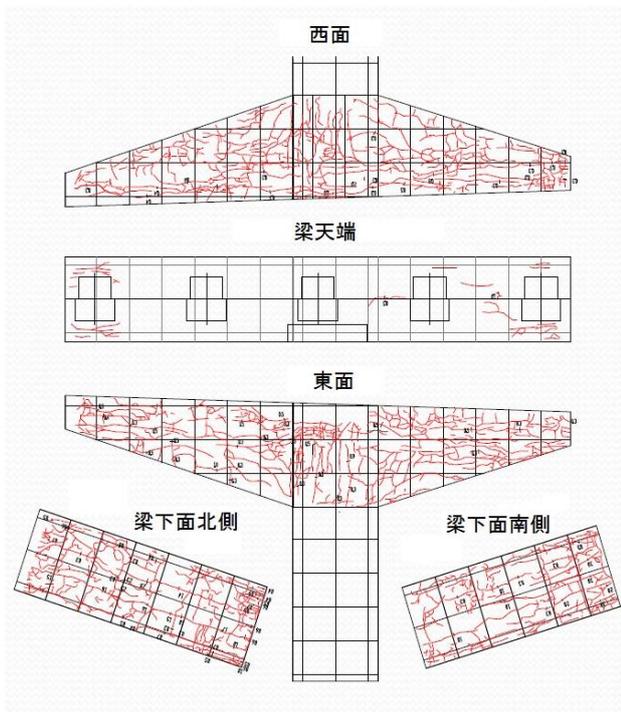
塗装除去後ひび割れ図（平成 21 年）
